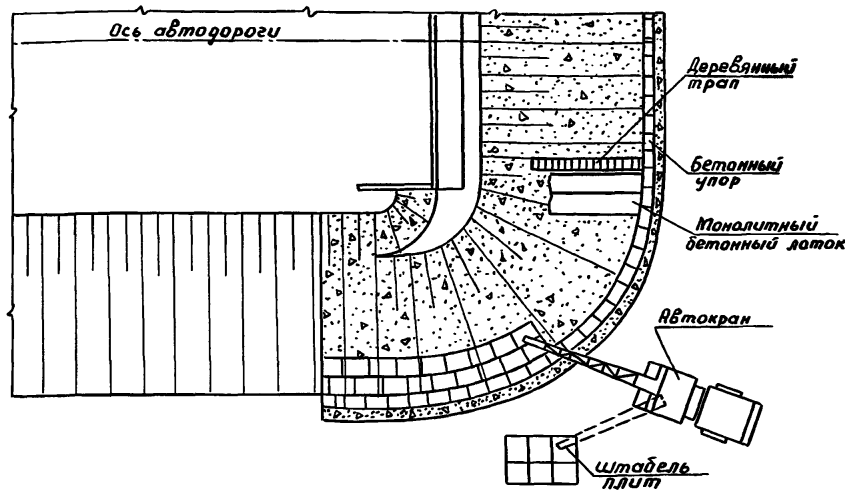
Укладка элементов решетчатых конструкций и устройство бетонных лотков
